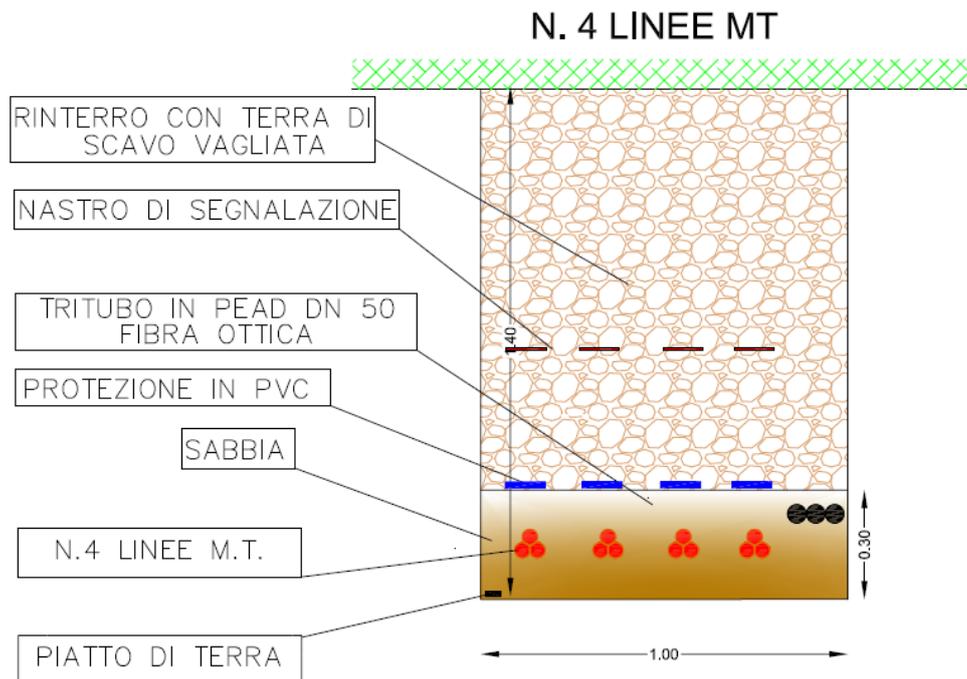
sezione tipo posa cavidotti MT su campo/banchina
